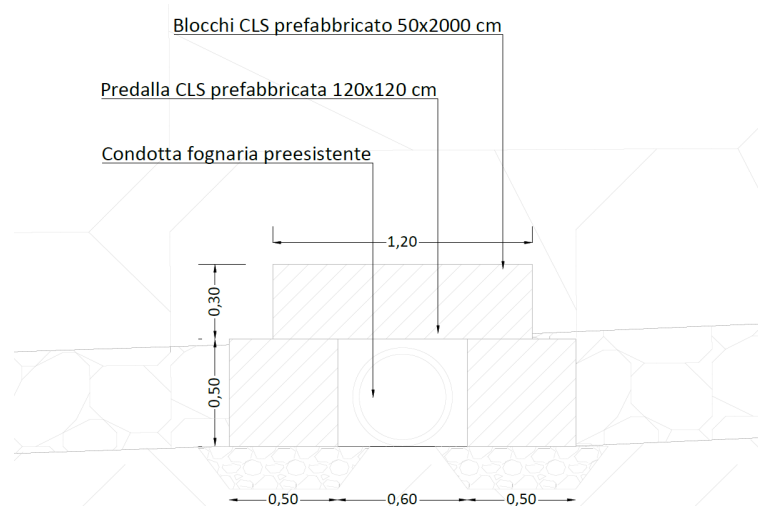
Sezione dell'intervento a protezione della condotta fognaria
